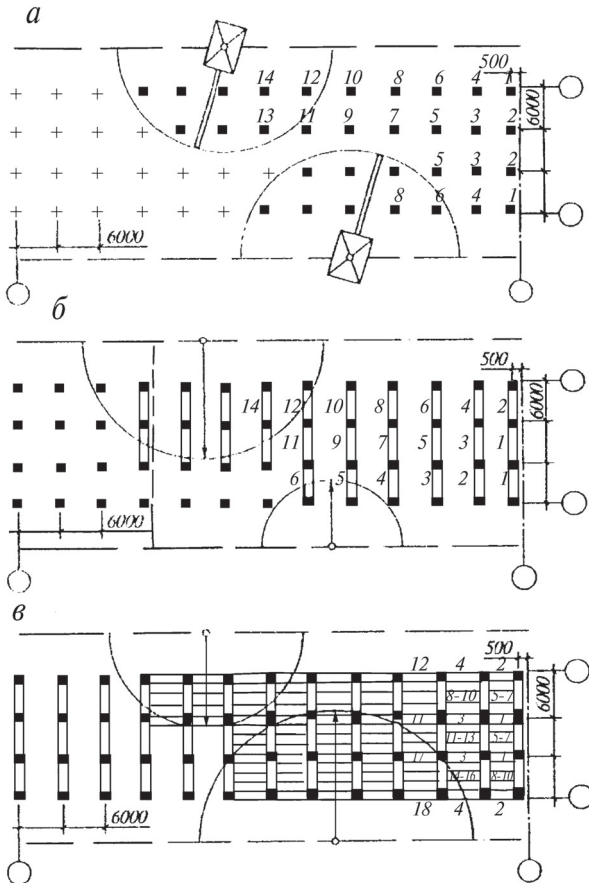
Схема монтажа бескрановых промышленных зданий двумя башенными кранами:
